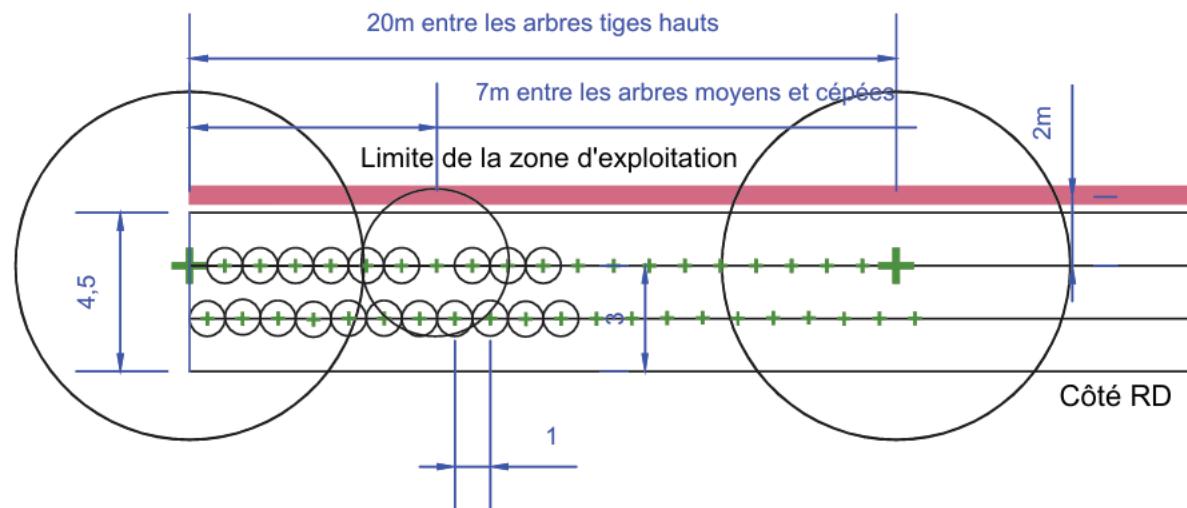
Plantation de la haie en partie basse du site au sud - distance de plantation
